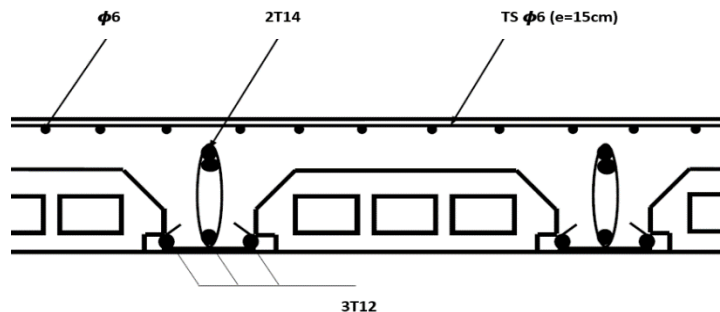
Schéma de ferrillage de plancher à corps creux.
